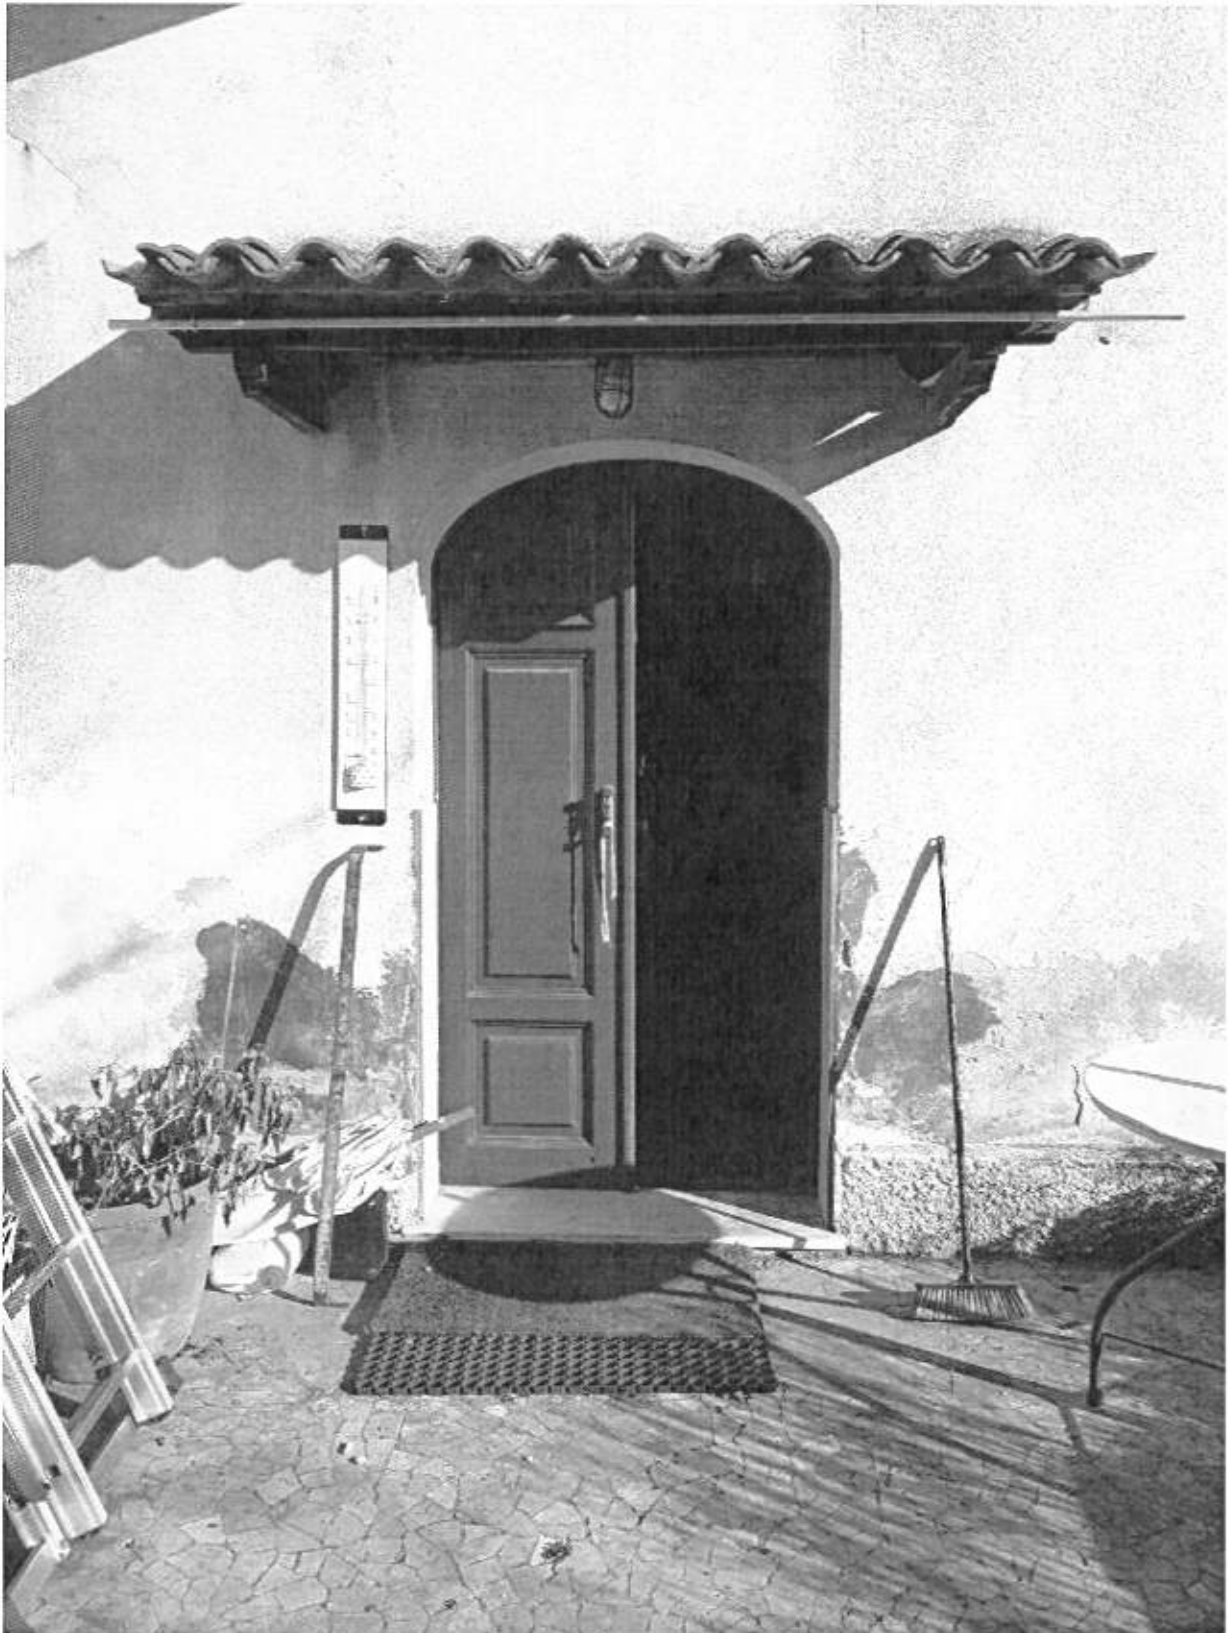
Piano Terra - Ingresso all'Abitazione
